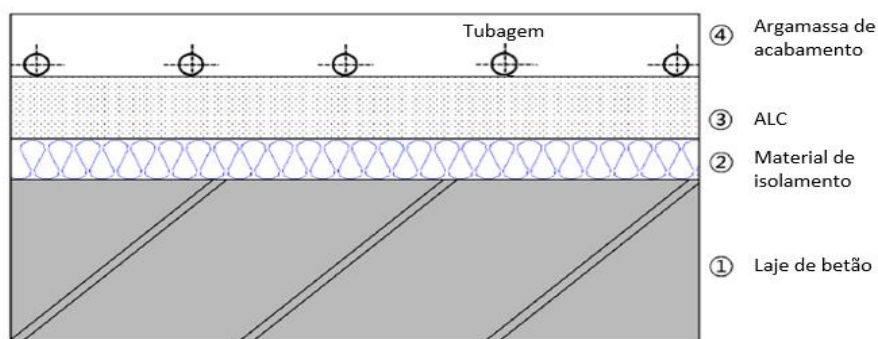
Pavimento radiante em construção húmida. Adaptado: [15]
